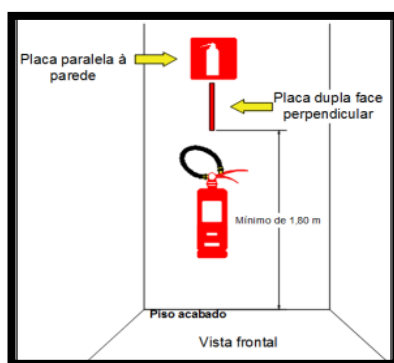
Placa com indicação extintor deve ser colocada a 1,80 do piso do chão.
